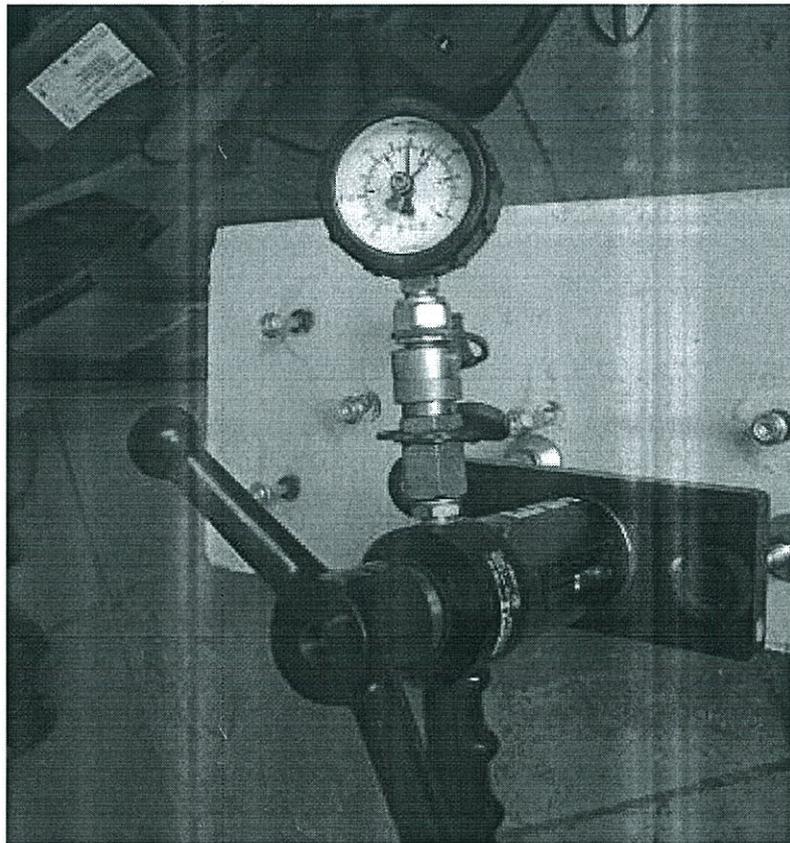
Испытание анкеров марки HRD, закреплённых в газобетонный блок
